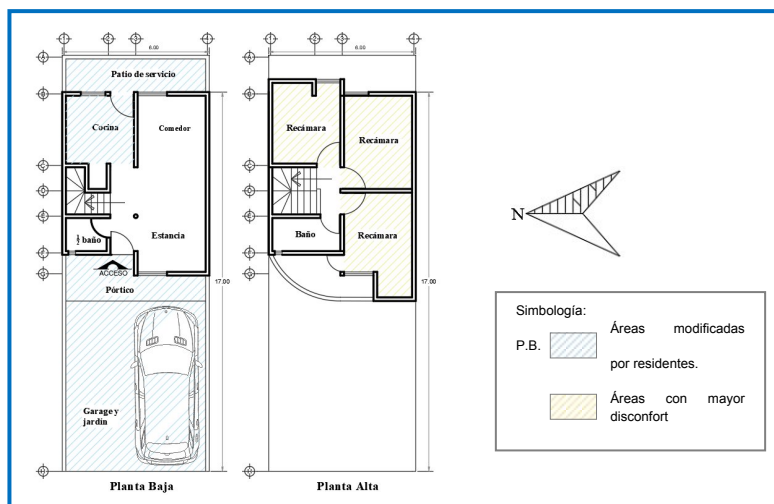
Planta arquitectónica tipo de VIS “Villas Parador”.
